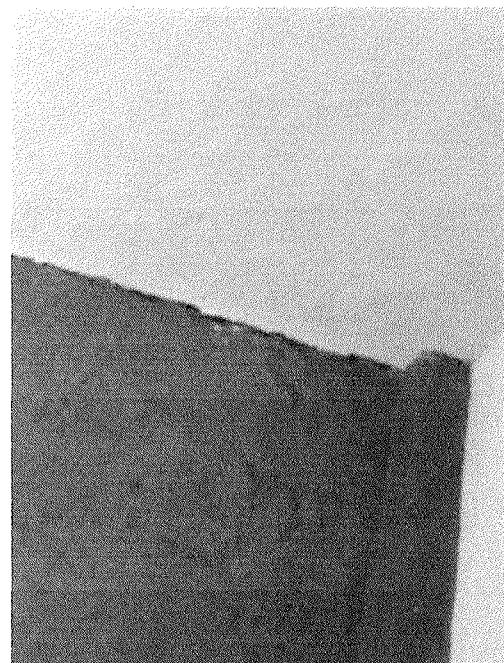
Rachadura na base da estrutura da edificação na parte exterior da escola
